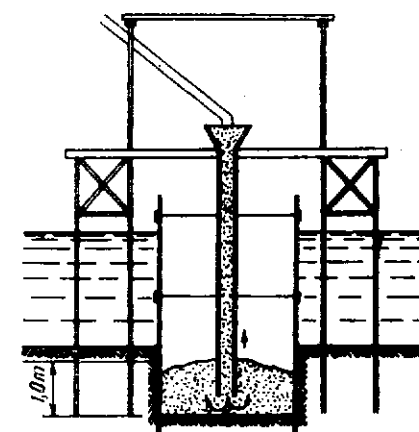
Turnarea betonului sub apă cu ajutorul pilniei fixe.
